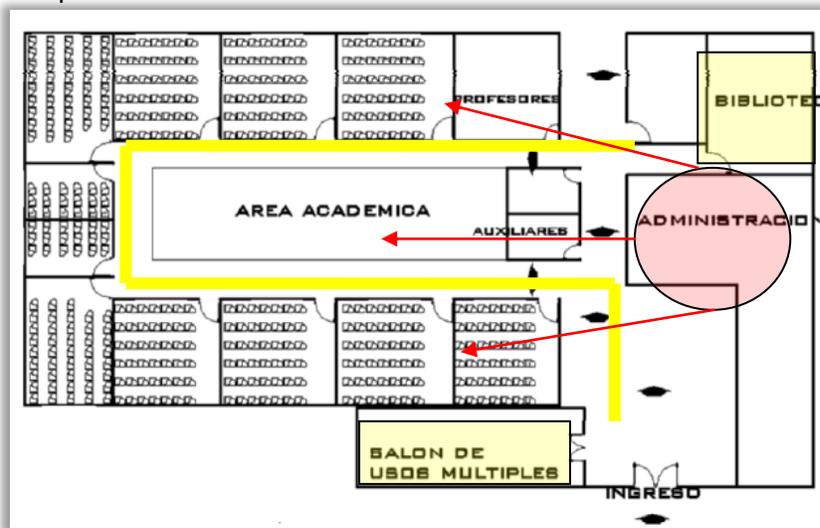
Planta de aulas académicas, Instituto Técnico Industrial. Fuente: Elaboración Propia.
